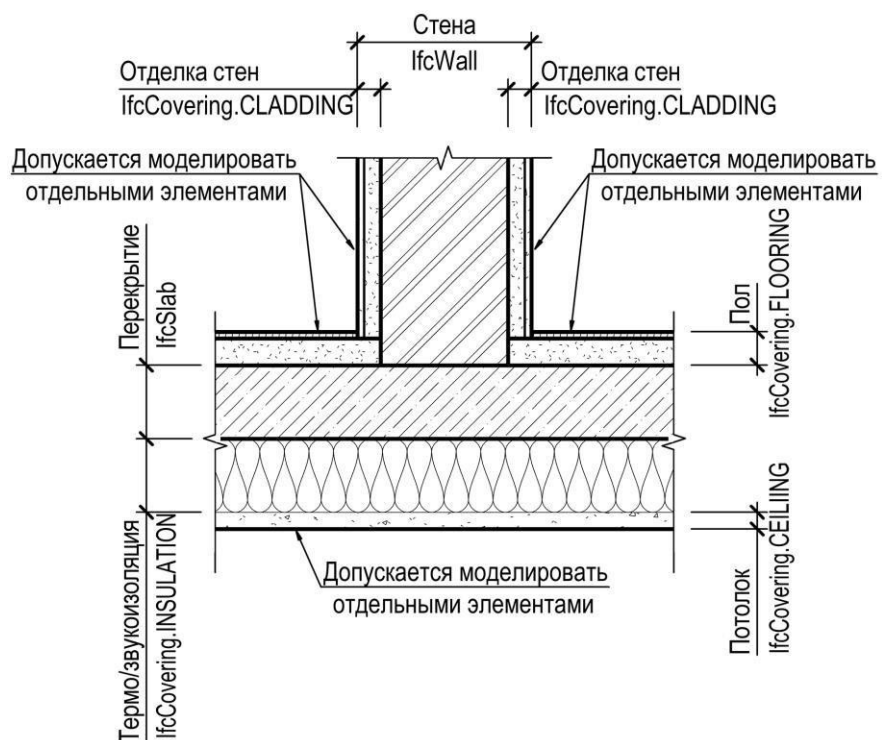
Пример моделирования элементов стен, перекрытий и отделки
